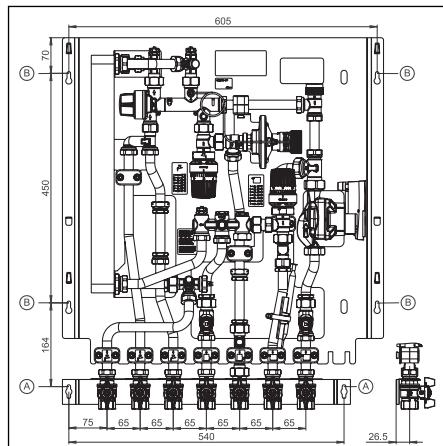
Anschlussschema Kugelhahnanschlussleiste 1341180
